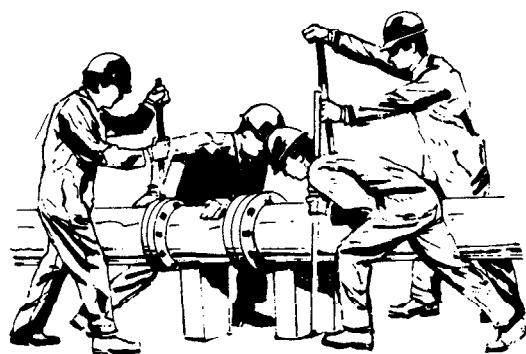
Desmontaje de una sección o "carrete" de tubo para instalar bridas ciegas
